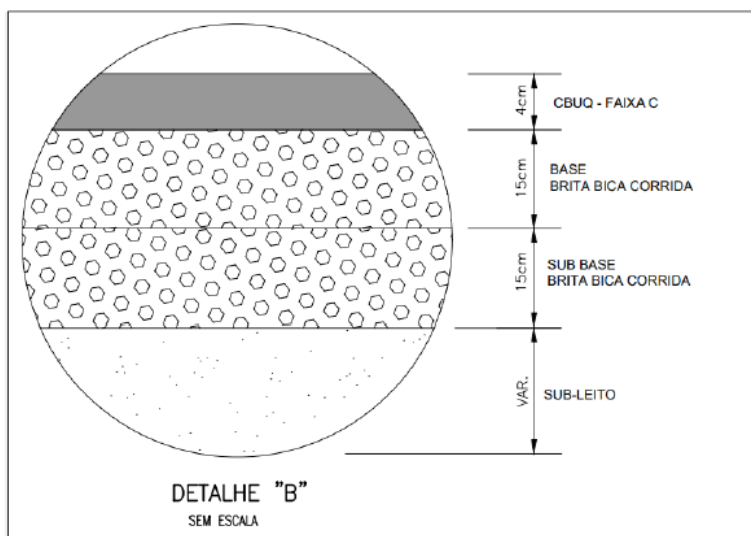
Detalhamento da Seção Tipo Pavimentação Rua Jason Armando de Paula / Rua A / Rua B
